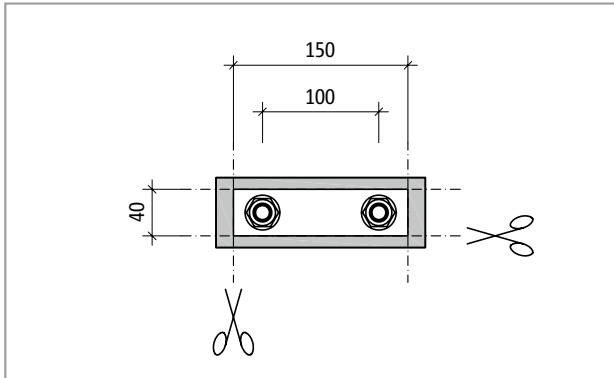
Schöck Isokorb® T tipo S-N: Dimensiones después de recortar el elemento aislante
